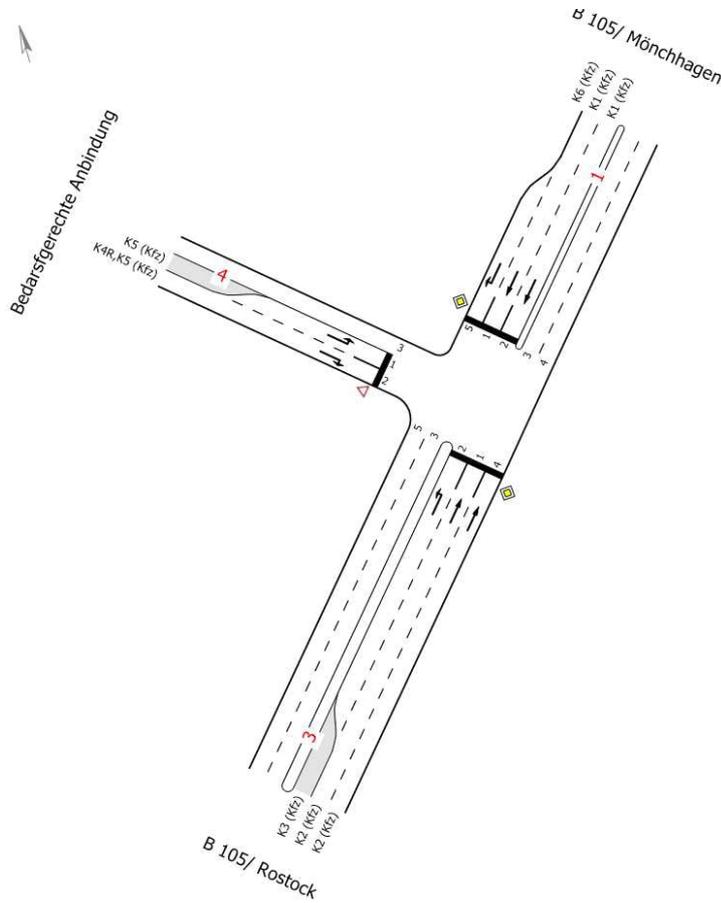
Knotenpunktschema KP5a – Plan-Ausbauzustand Planfall 1
